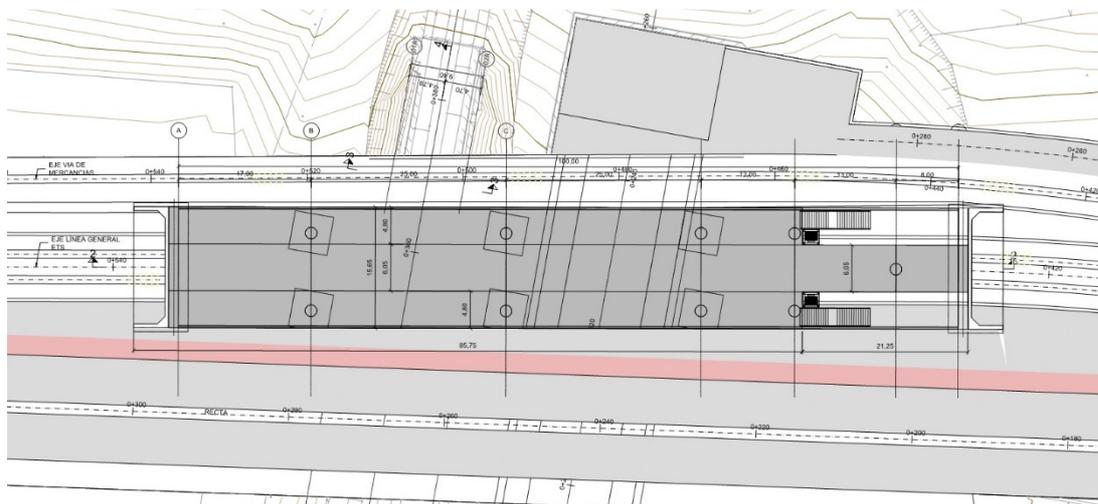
Planta Viaducto de ETS en el edificio intercambiador
